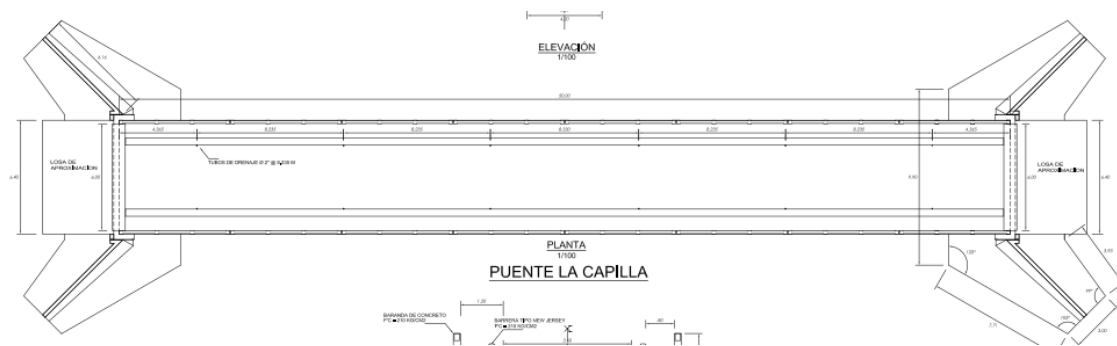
Vista en planta puente La Capilla. (P-1 Anexo4)
